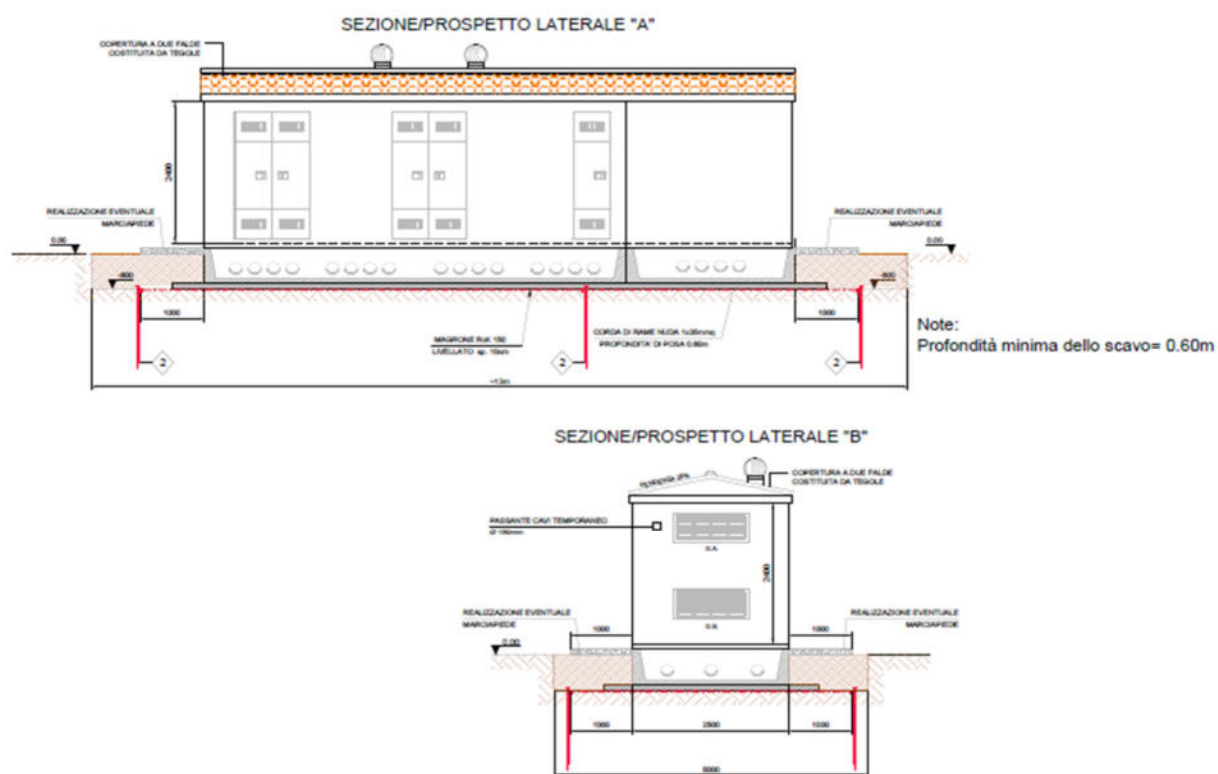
LAYOUT CABINA DI CONSEGNA_SEZIONI E PROSPETTI
